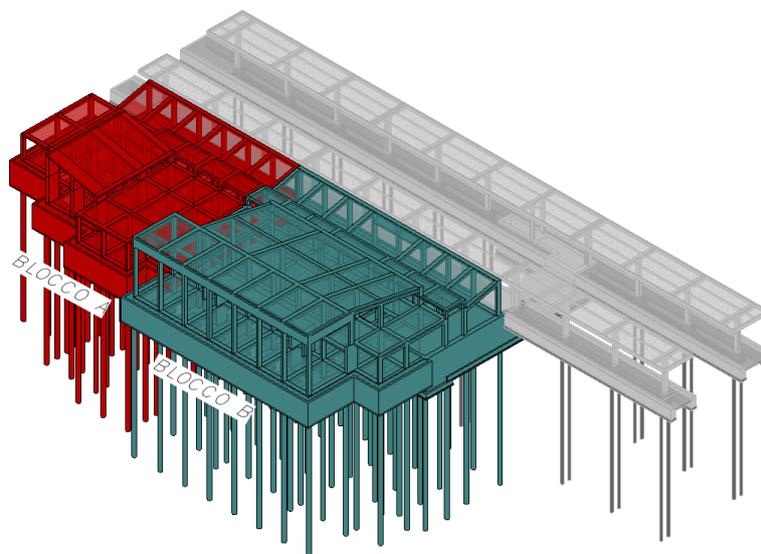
Vista assometrica del Fabbricato oggetto di intervento – Blocco A e Blocco B
